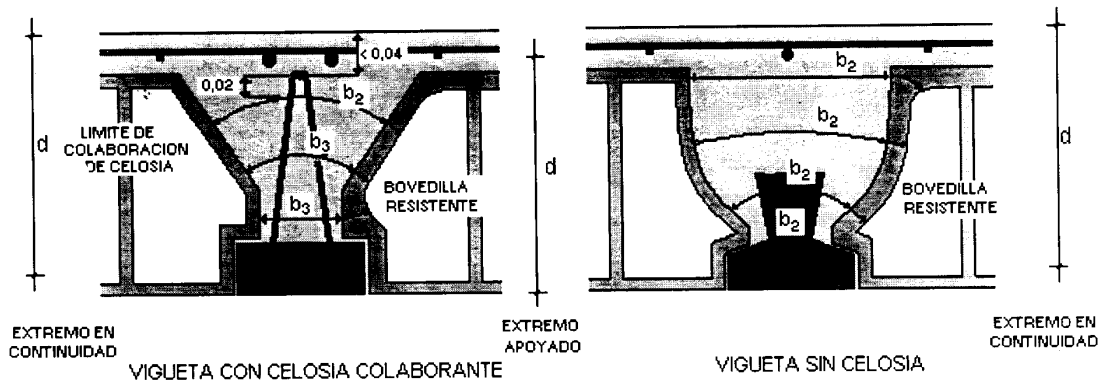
Anchos para comprobar el esfuerzo cortante en vigüetas armadas con armadura transversal.
